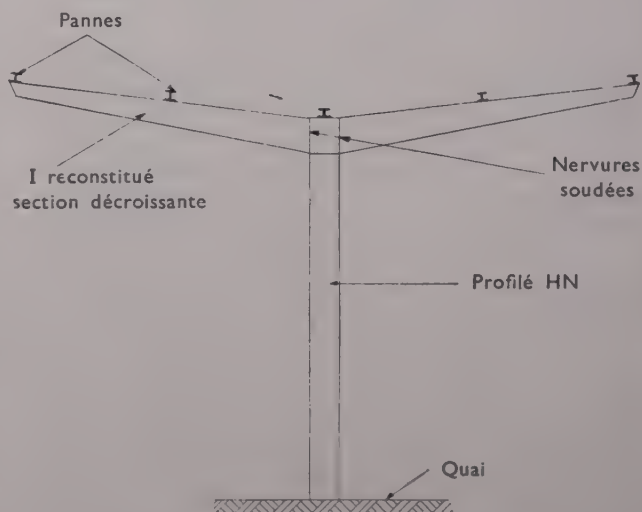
Abri de quai. Ossature métallique entièrement soudée.
